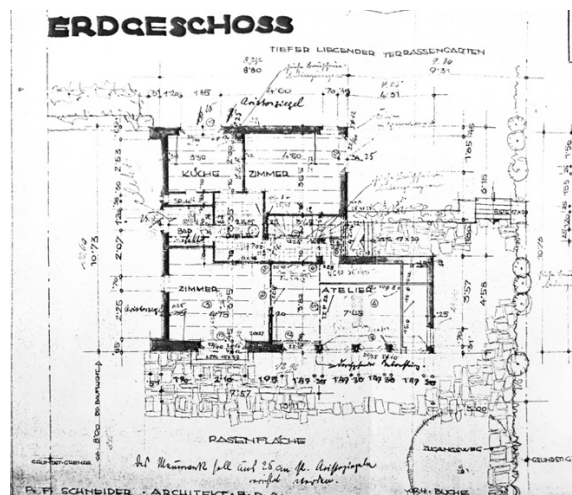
P. F. Schneider, Haus Schneider, Grundriss Erdgeschoss
